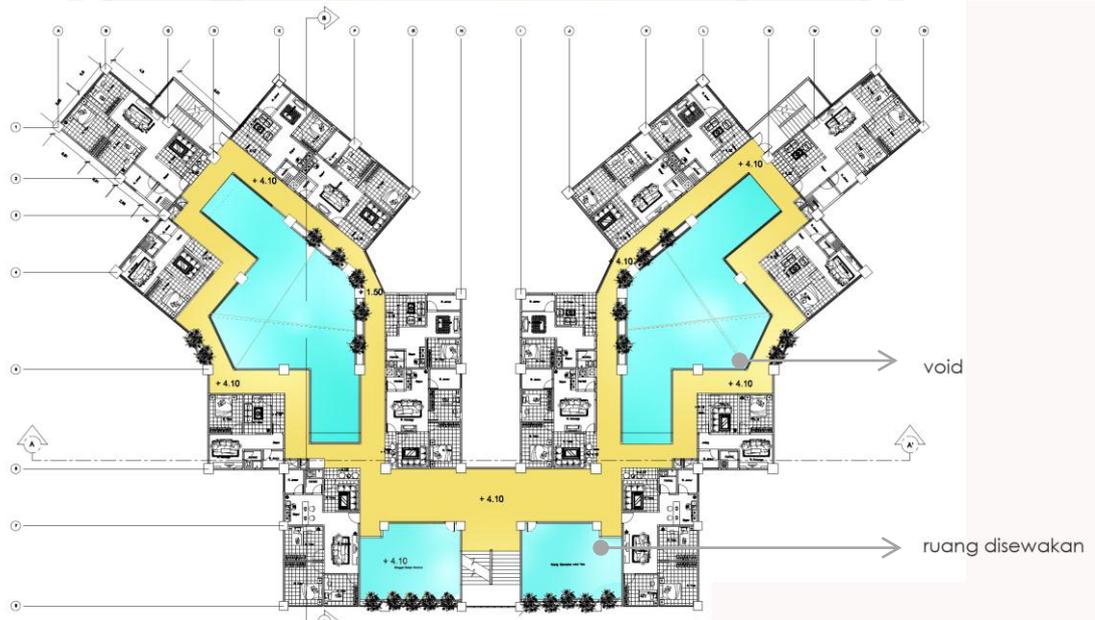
Denah lantai I blok apartemen II dan III
